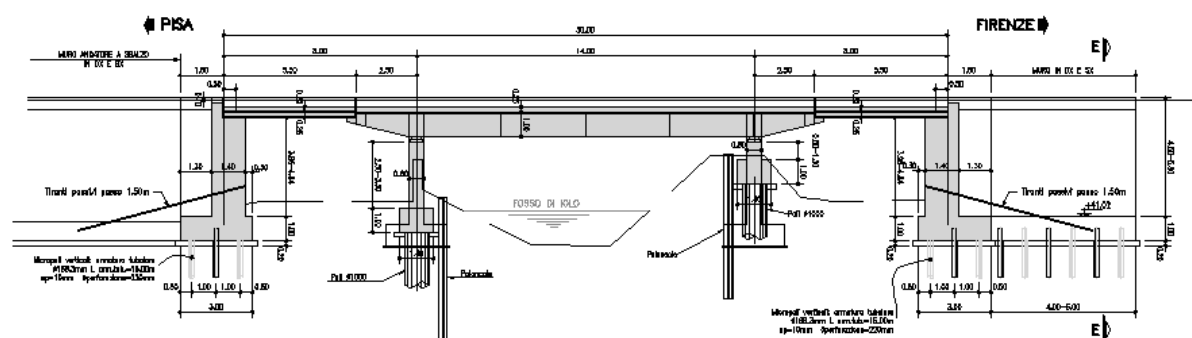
Viadotto sul F. Iolo. Sezione longitudinale
